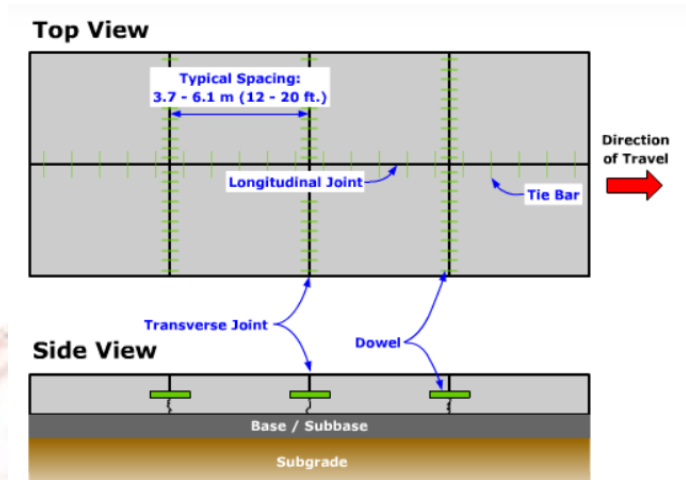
โครงสร้างของ Rigid Pavement โดยทั่วไป
